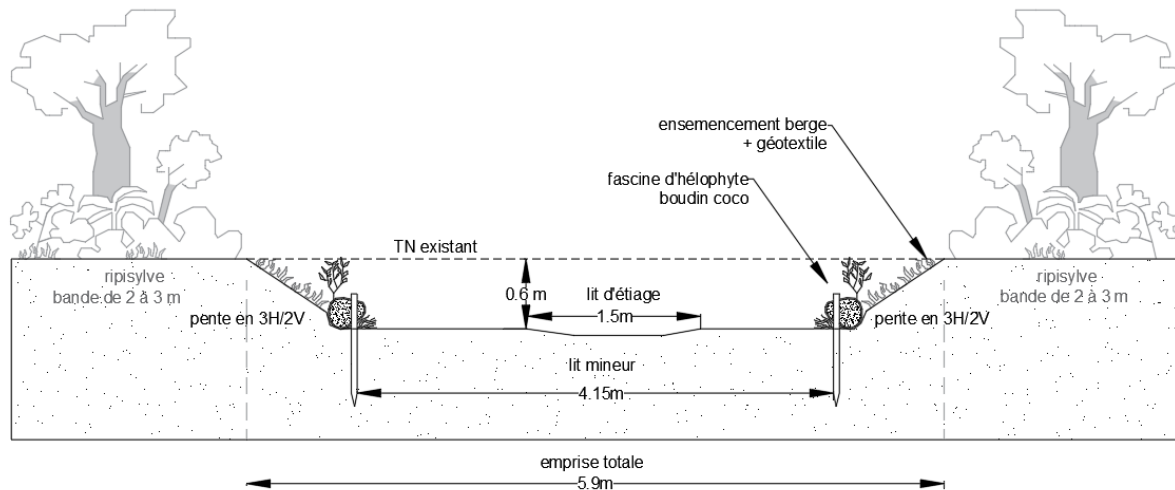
Coupe type du nouveau lit au plus défavorable de la rehausse de radier
